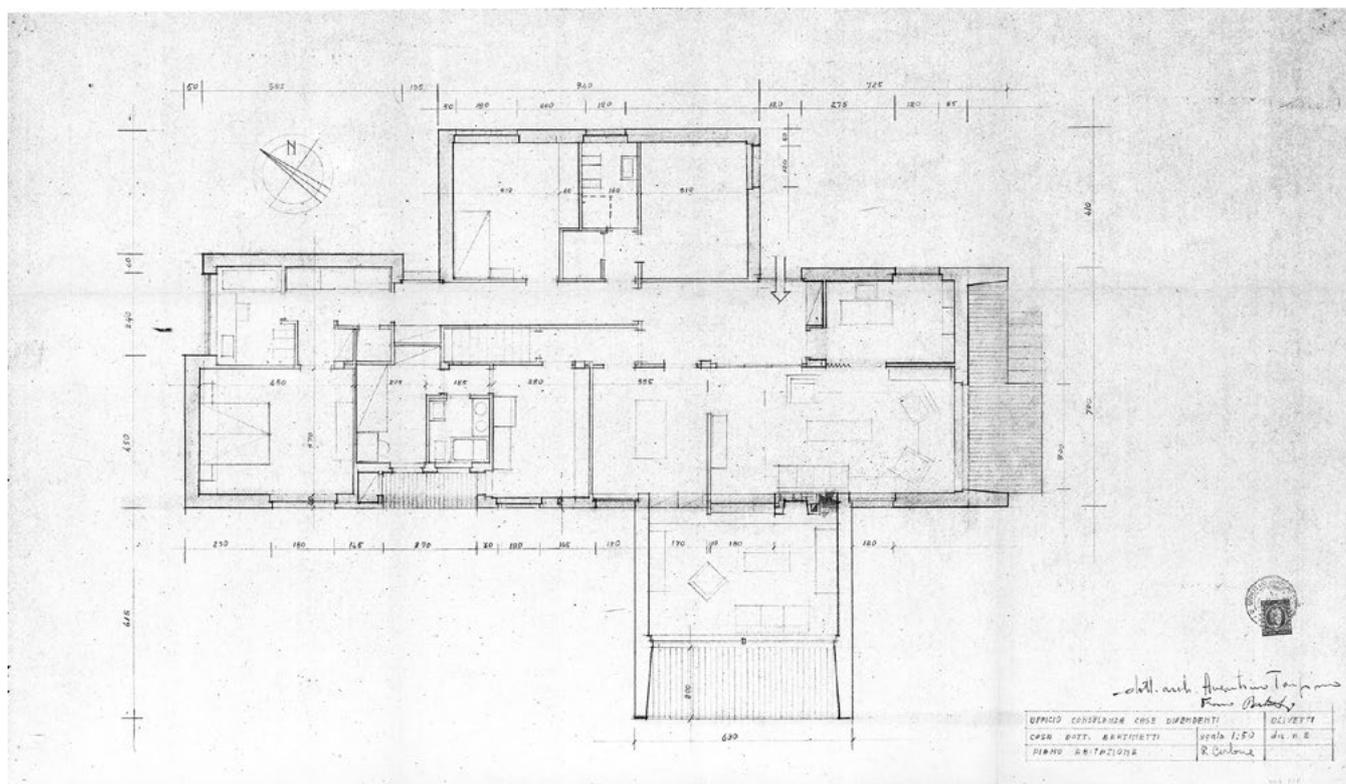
Pianta definitiva di villa Bertinetti (Archivio Edilizio Comune di Banchette).
